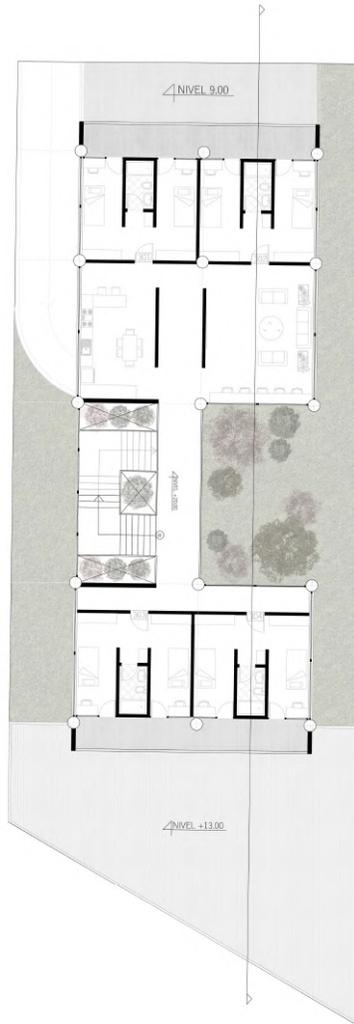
Tercera planta N 20.00 Vivienda becarios. Elaboración Propia
